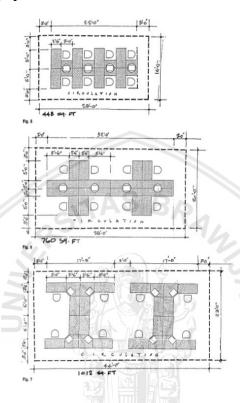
Contoh layout ruang kerja privat sumber : De Chiara, Joseph, et al. 2001
